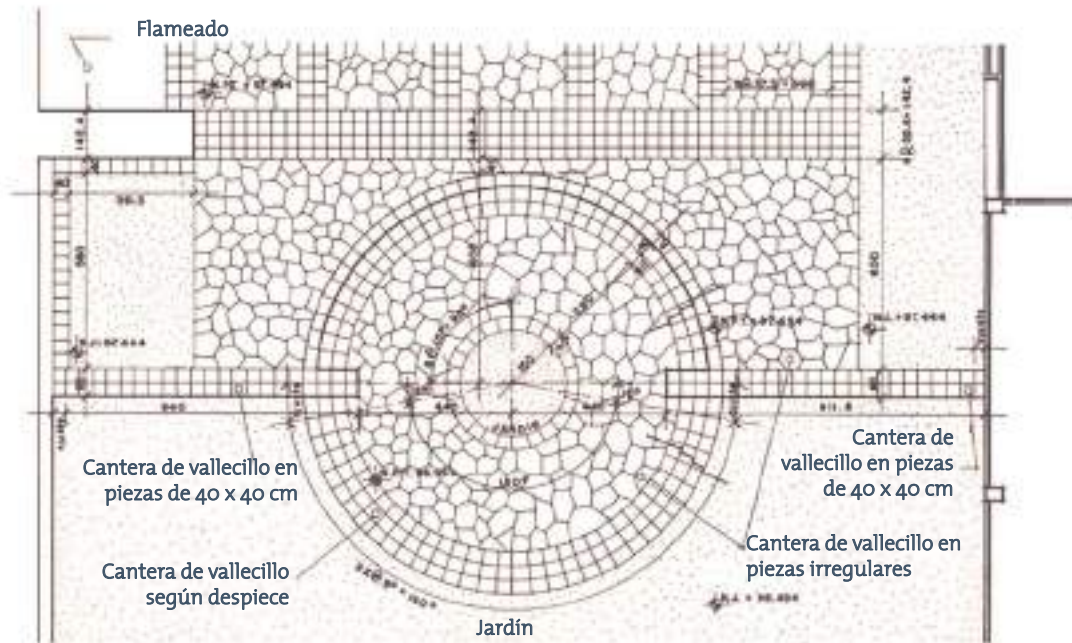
Detalle de escalera en plaza, corporativo DeAcero, Monterrey, Nuevo León
